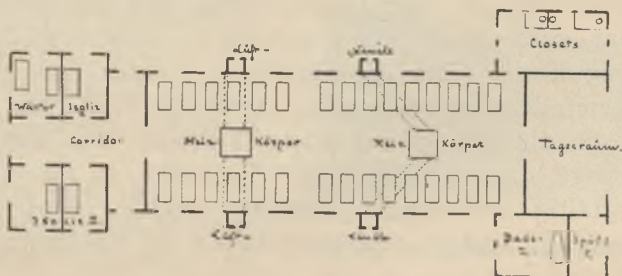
Pavillon des Hamburger Krankenhauses (nach Deneke).
